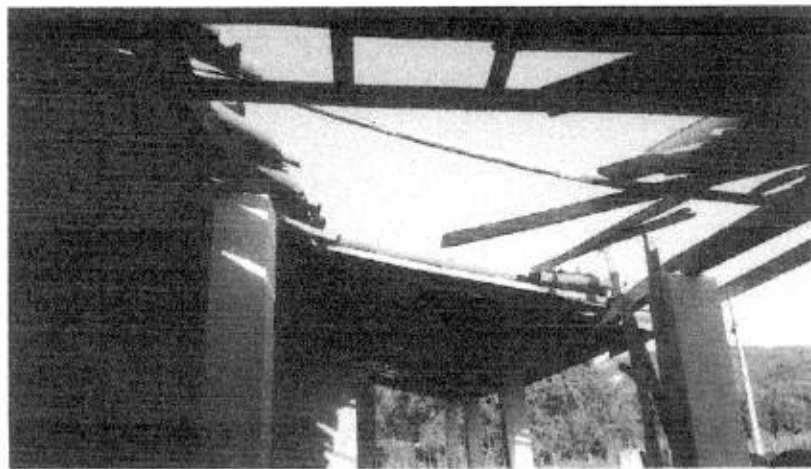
Coberta da edificação, com pontos de desabamento e completo comprometimento da estrutura de madeira
